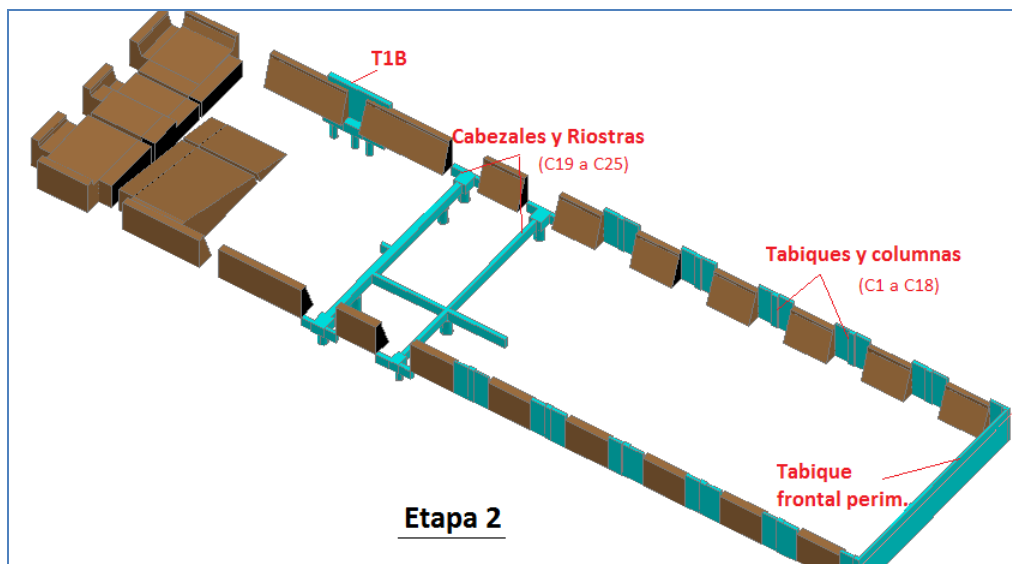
Esquema de los tabiques, vigas riostras y cabezales hormigonados en la segunda etapa.
